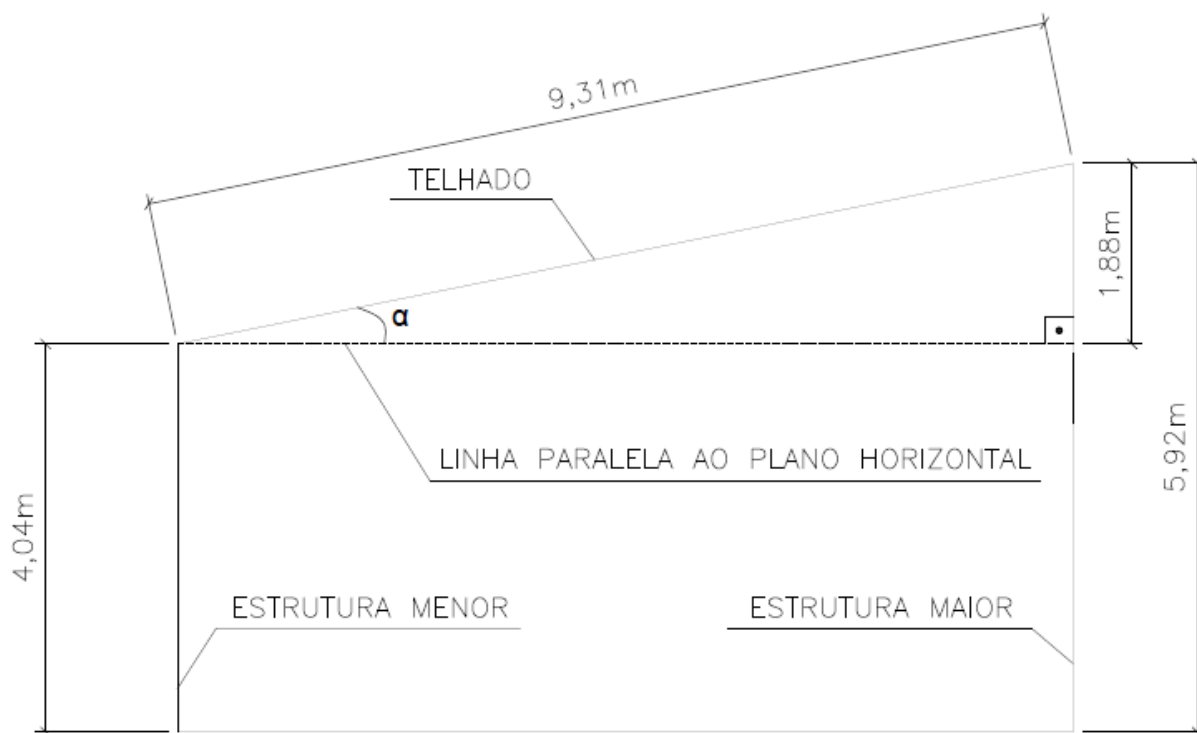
Inclinação do telhado em relação ao plano horizontal
